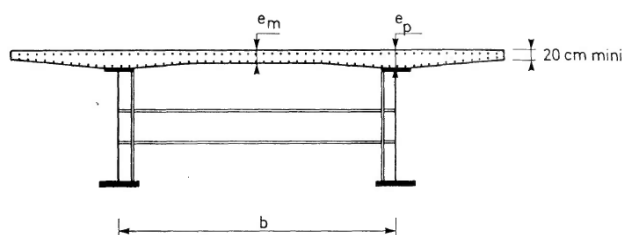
Coupe transversale d'un pont mixte bipoutre (SETRA, 1985).
